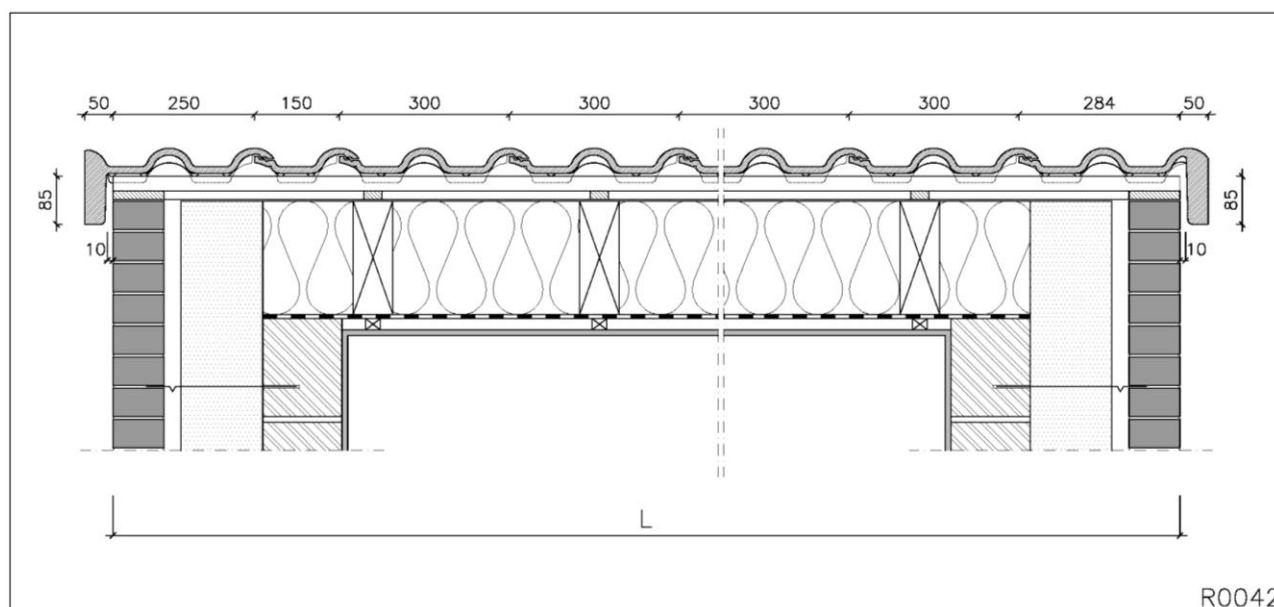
Breedteverdeling HEIDELBERG betondakpannen en gevelpannen
